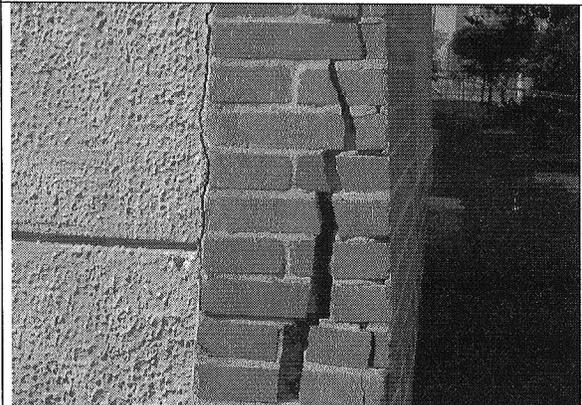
Separación del muro de fachada exterior de la estructura de la edificación.
